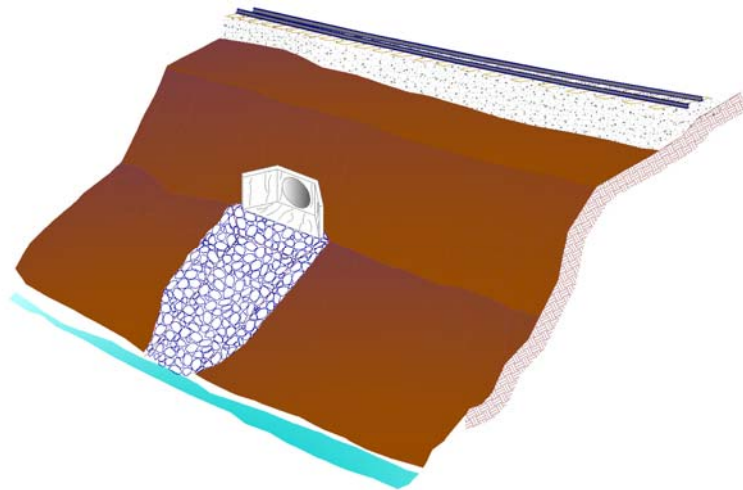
modelo esquemático da transposição das drenagens por meio de bueiros
